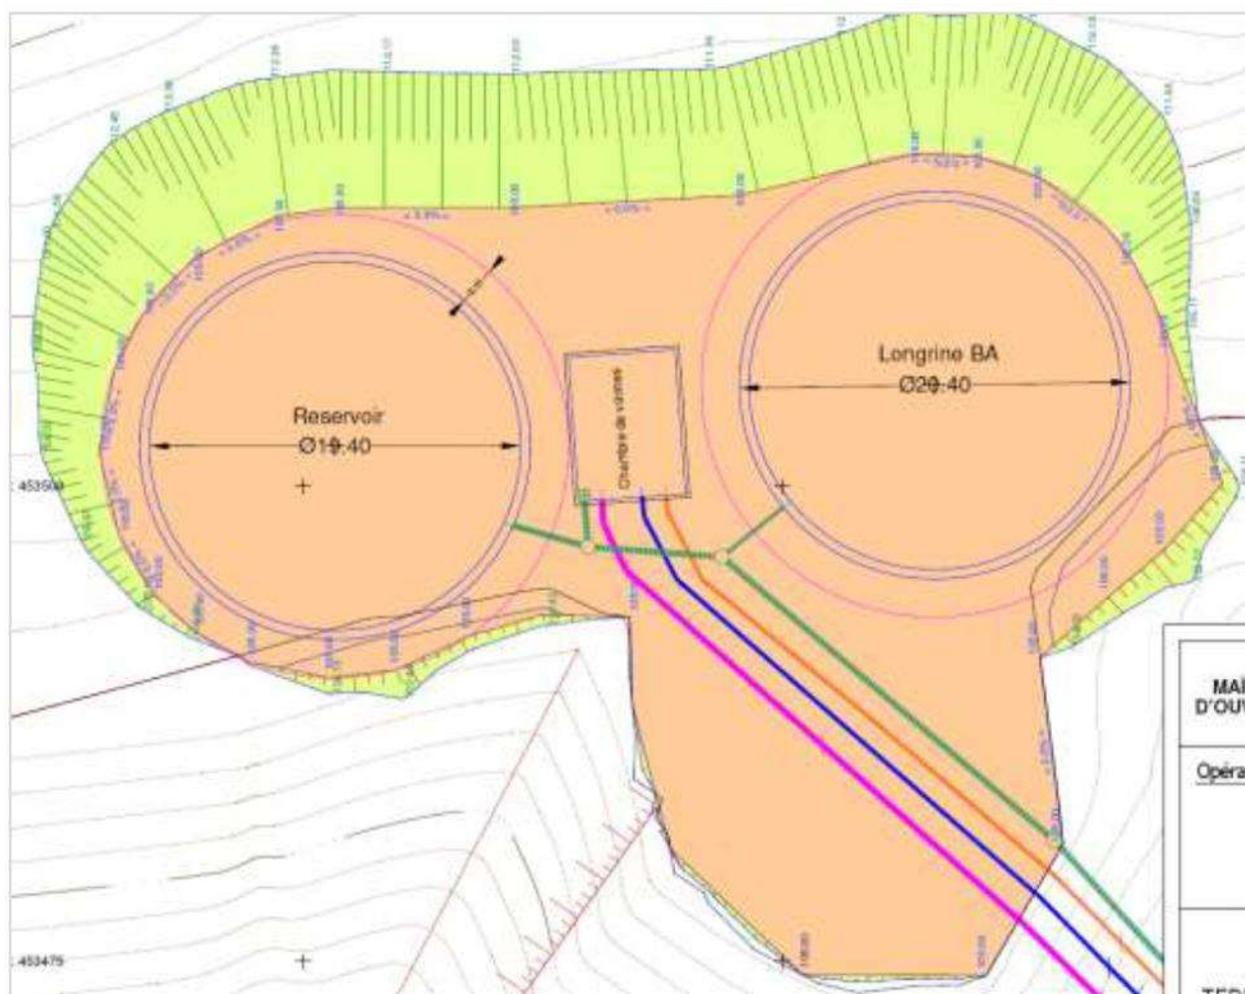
plan de terrassement de la plateforme (Eau NC, 2018).
